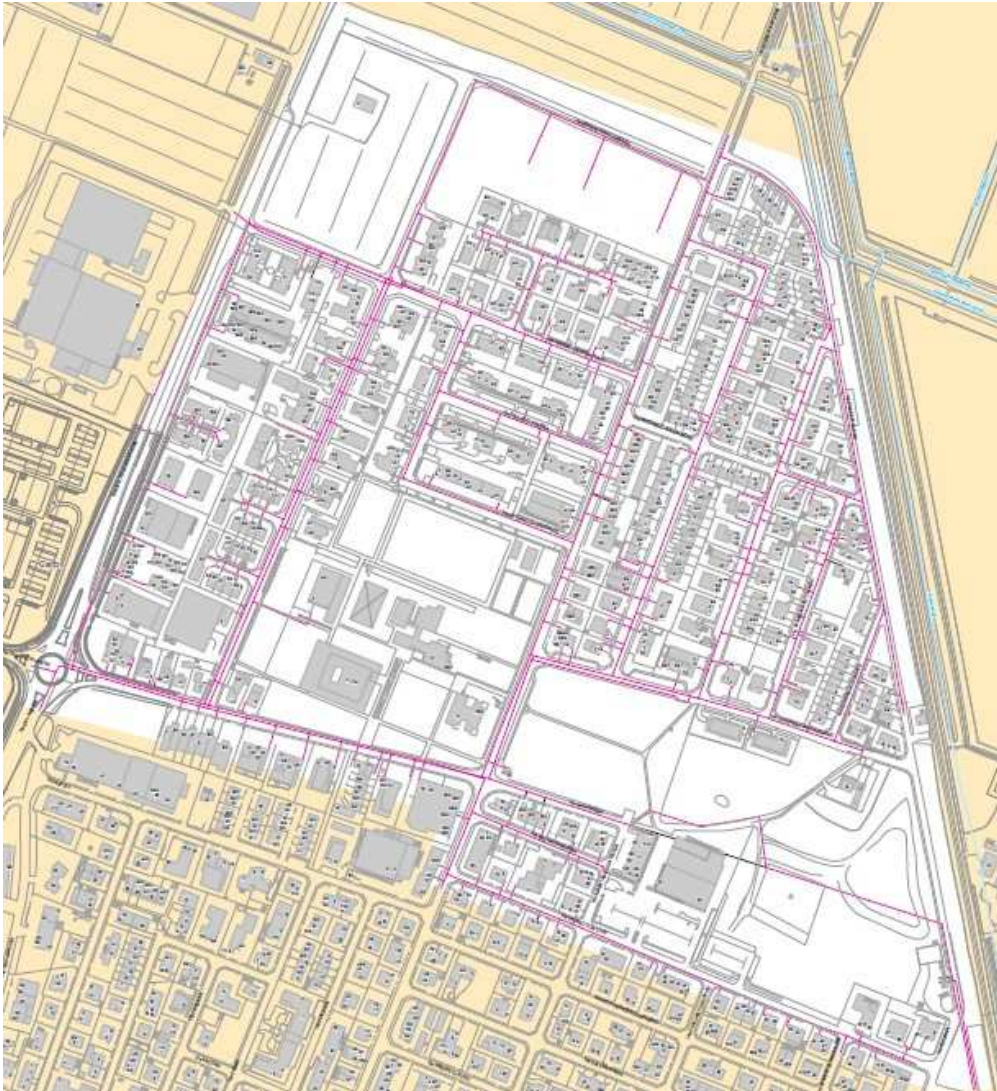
\_ Planimetria sottoservizi esistenti fornita da ASRETIGAS\_ Rete gas
